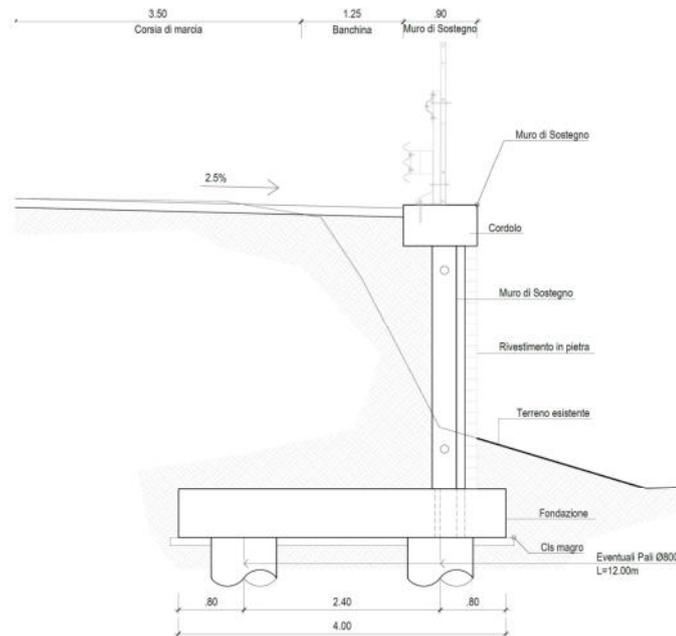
Sezione trasversale muri di sostegno con fondazione su pali
